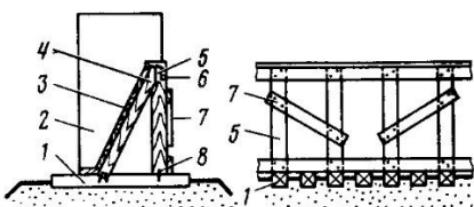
Опалубка ножа некруглого в плане колодца:
